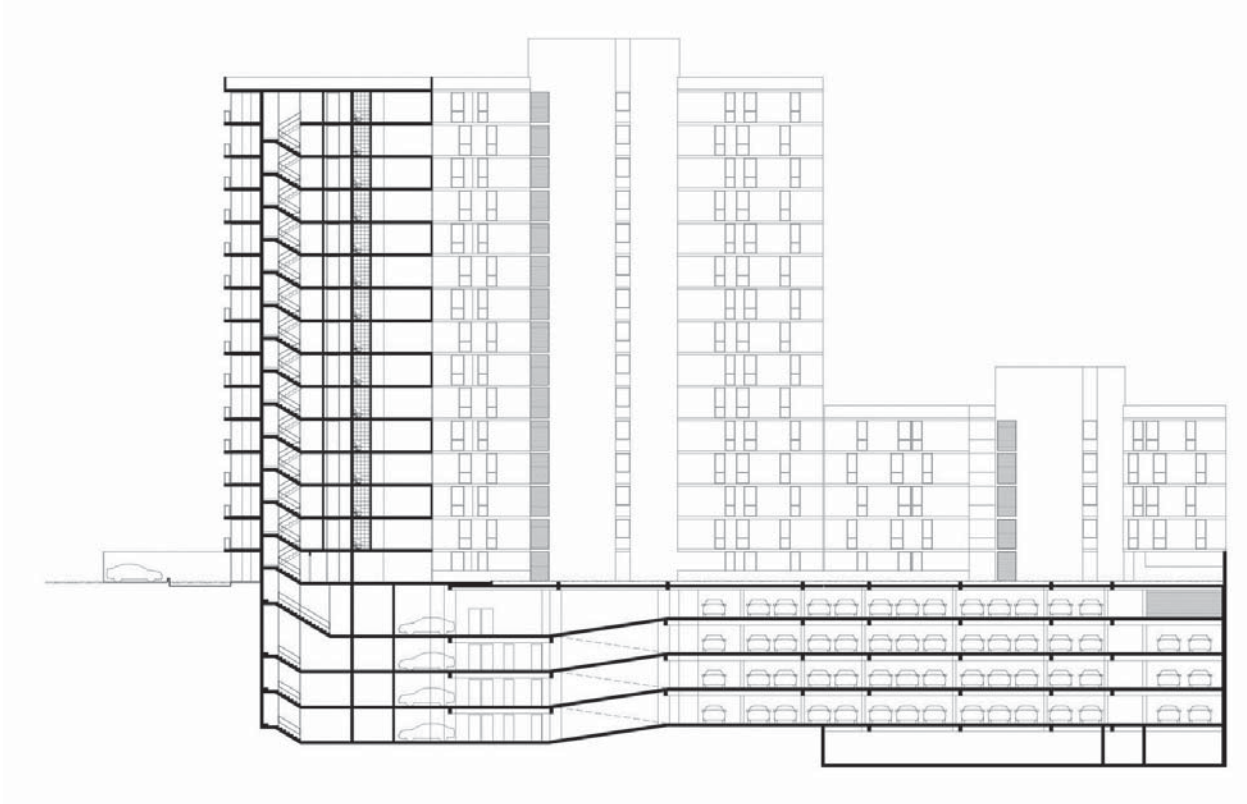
Fachadas Exterior e Interior Conjunto Residencial Cipreses.
